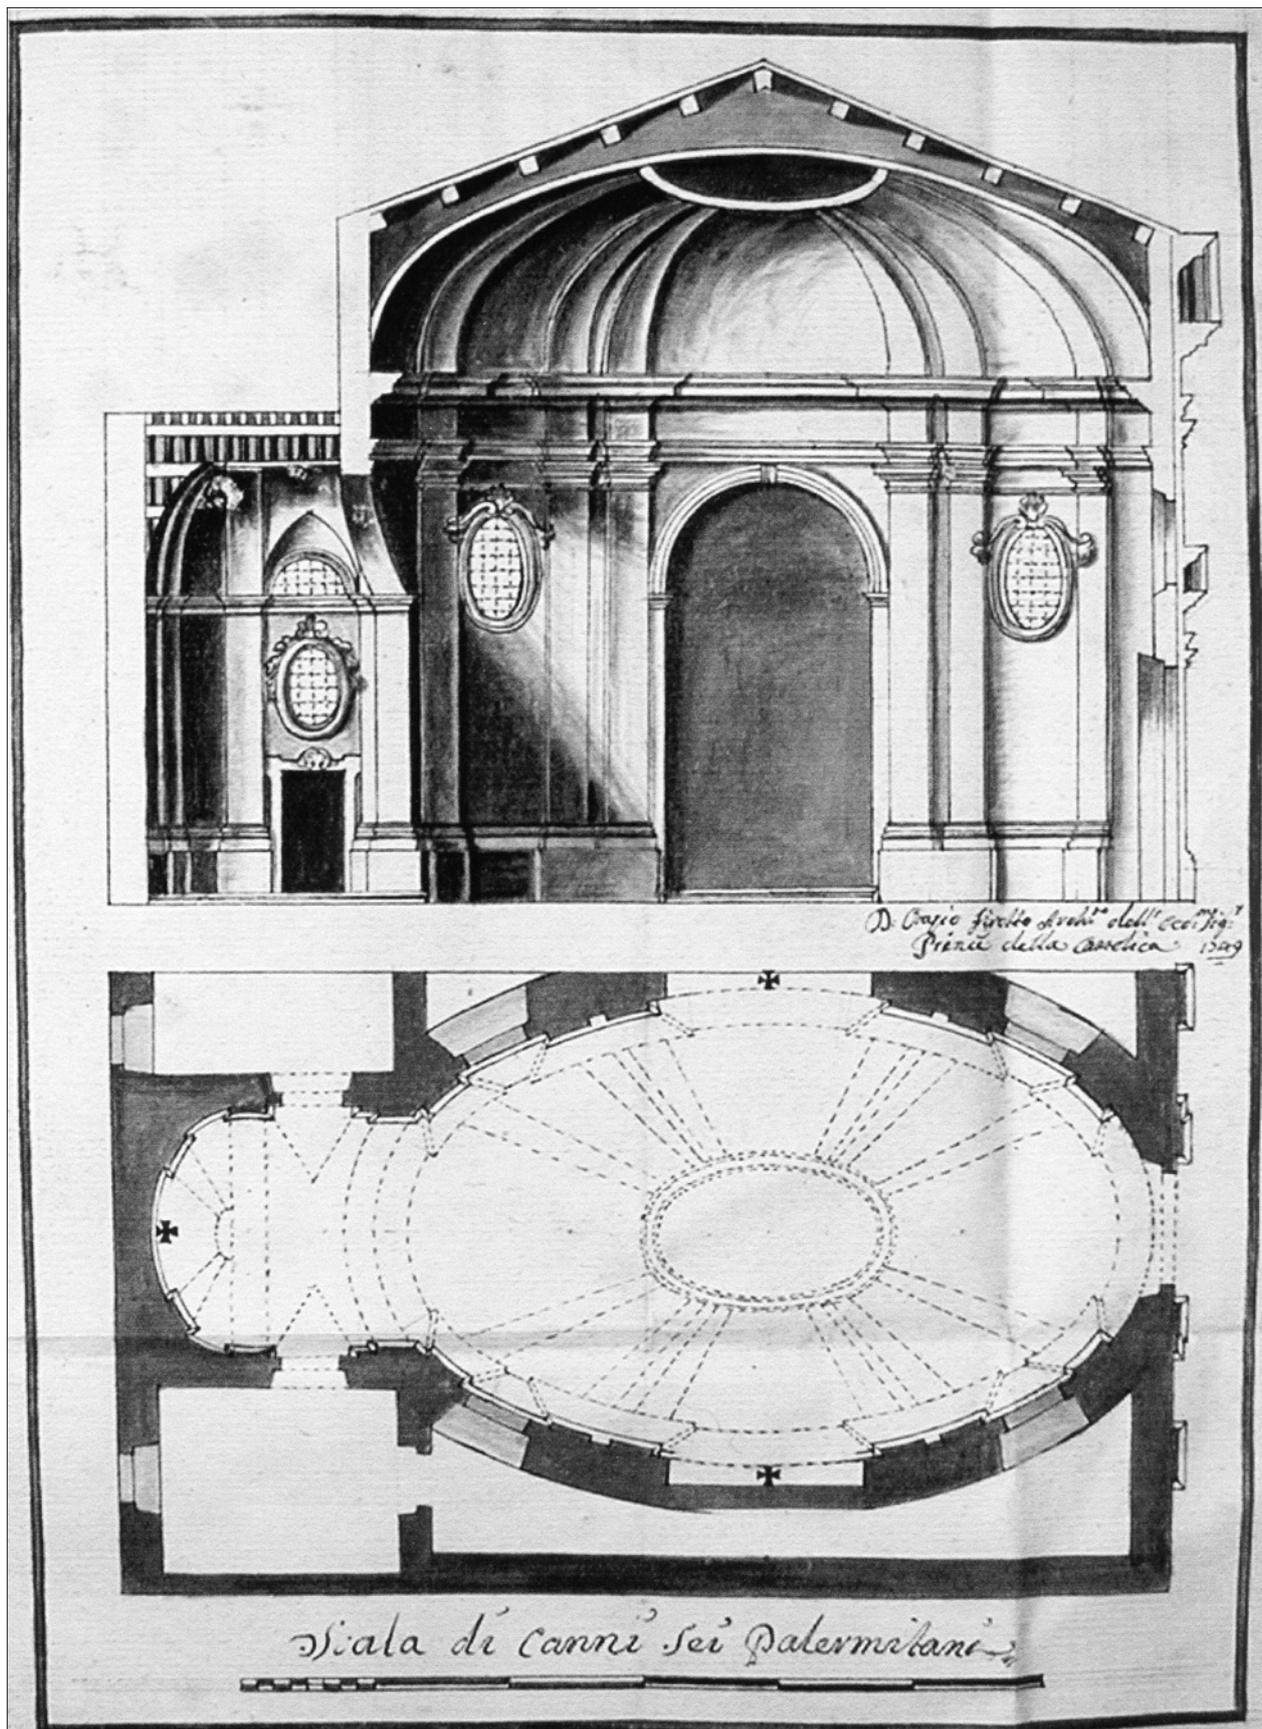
Corleone, sezione e pianta della chiesa di S. Giovanni Battista (Magione 368)
